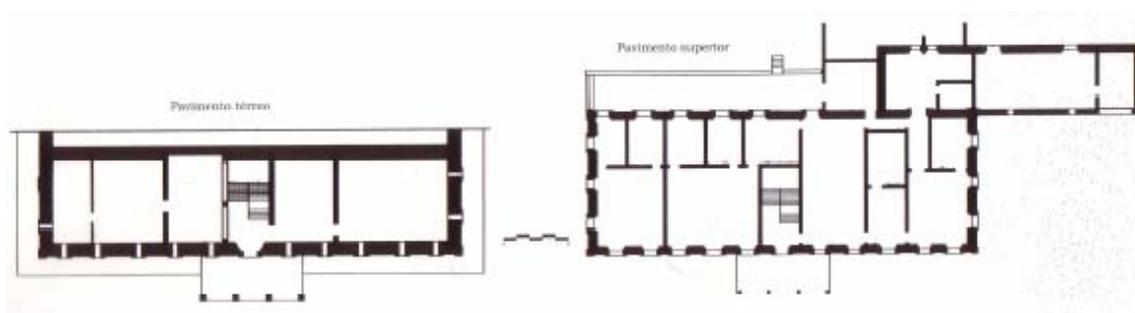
Plantas Baixas da Casa Grande do Engenho Matapiruna, em Escada -PE
